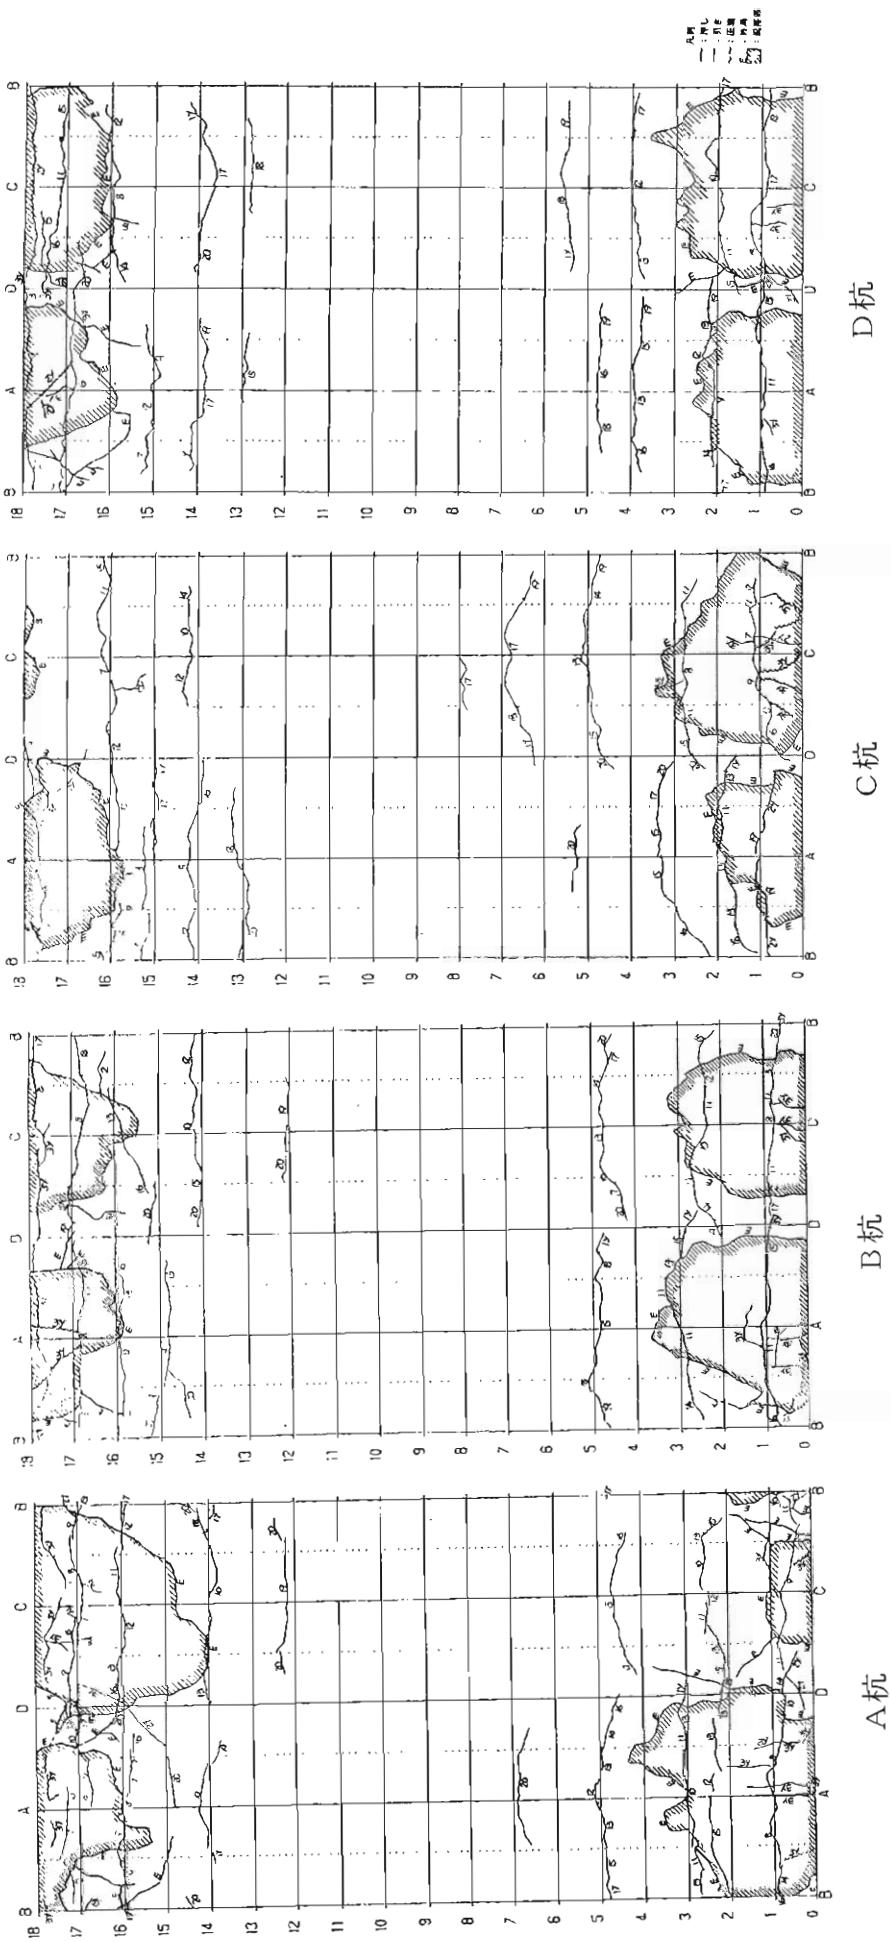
桁体のひび割れ状況展開図 (ケース10、1δy)
